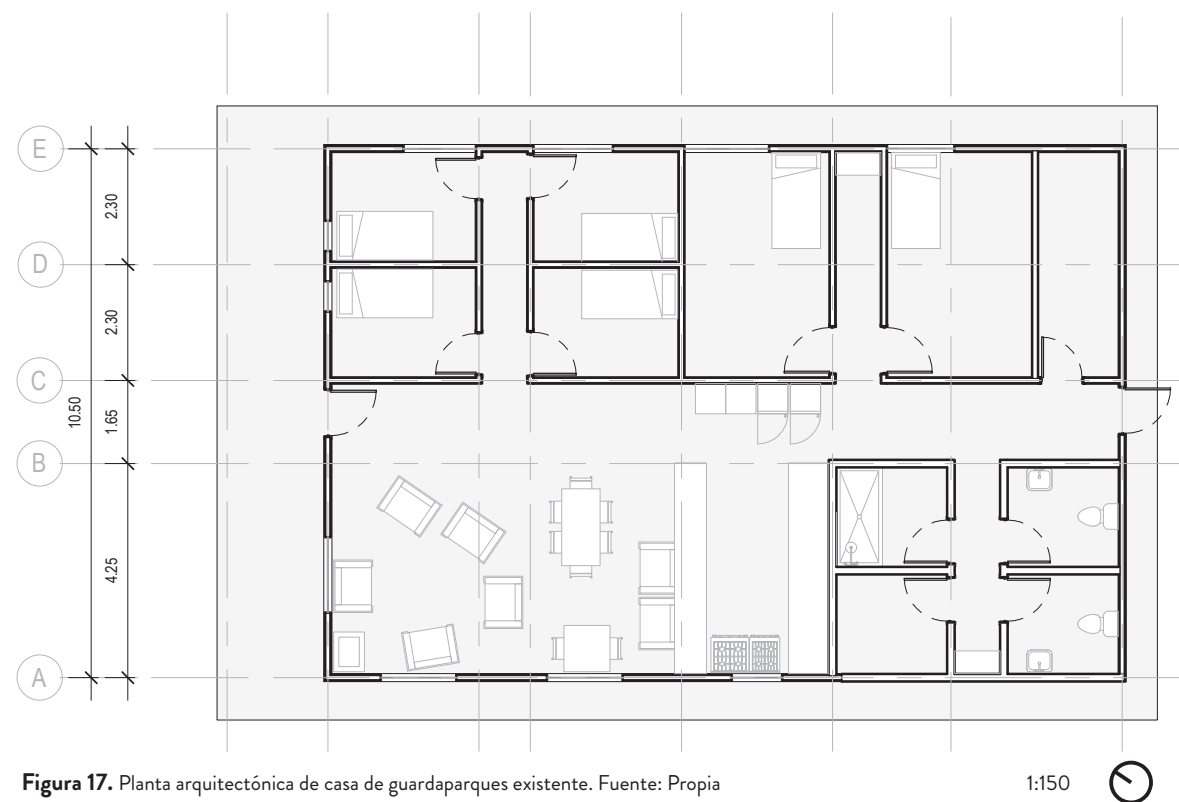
Planta arquitectónica de casa de guardaparques existente. Fuente: Propia
